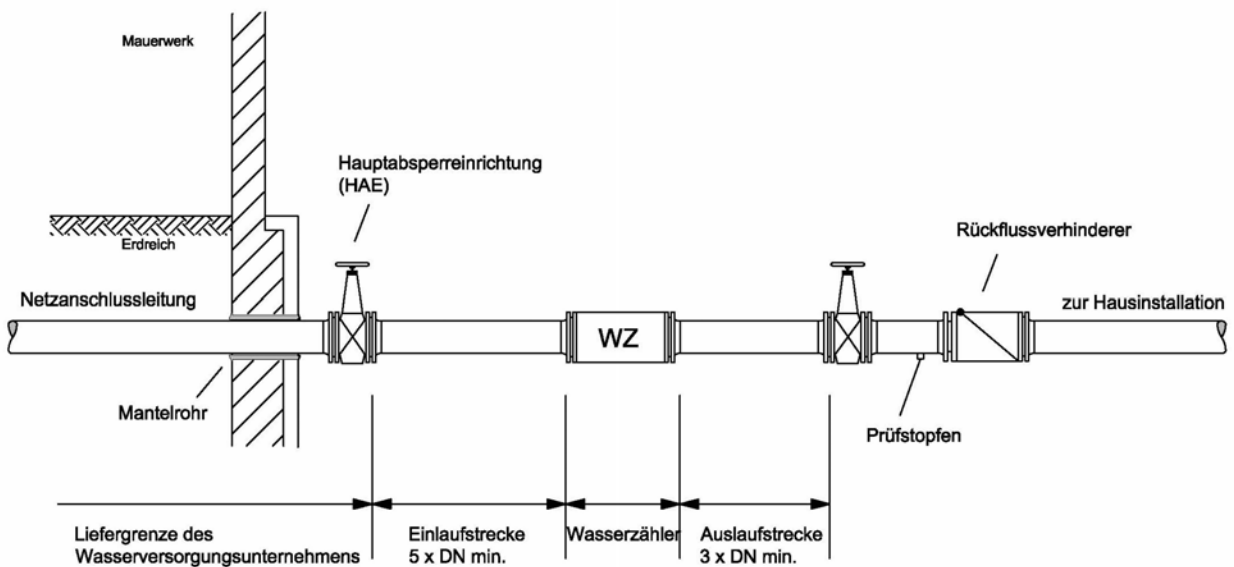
Installationsschema für Großwasserzähler ab Qn 15
